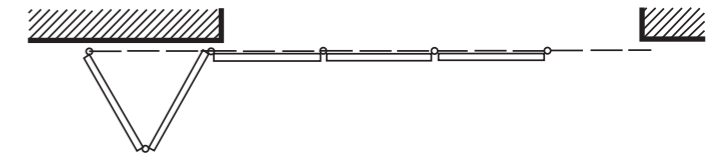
Puerta plegable deslizante. (Fuente, Fig. 8 de UNE EN 12433-1:2000)
